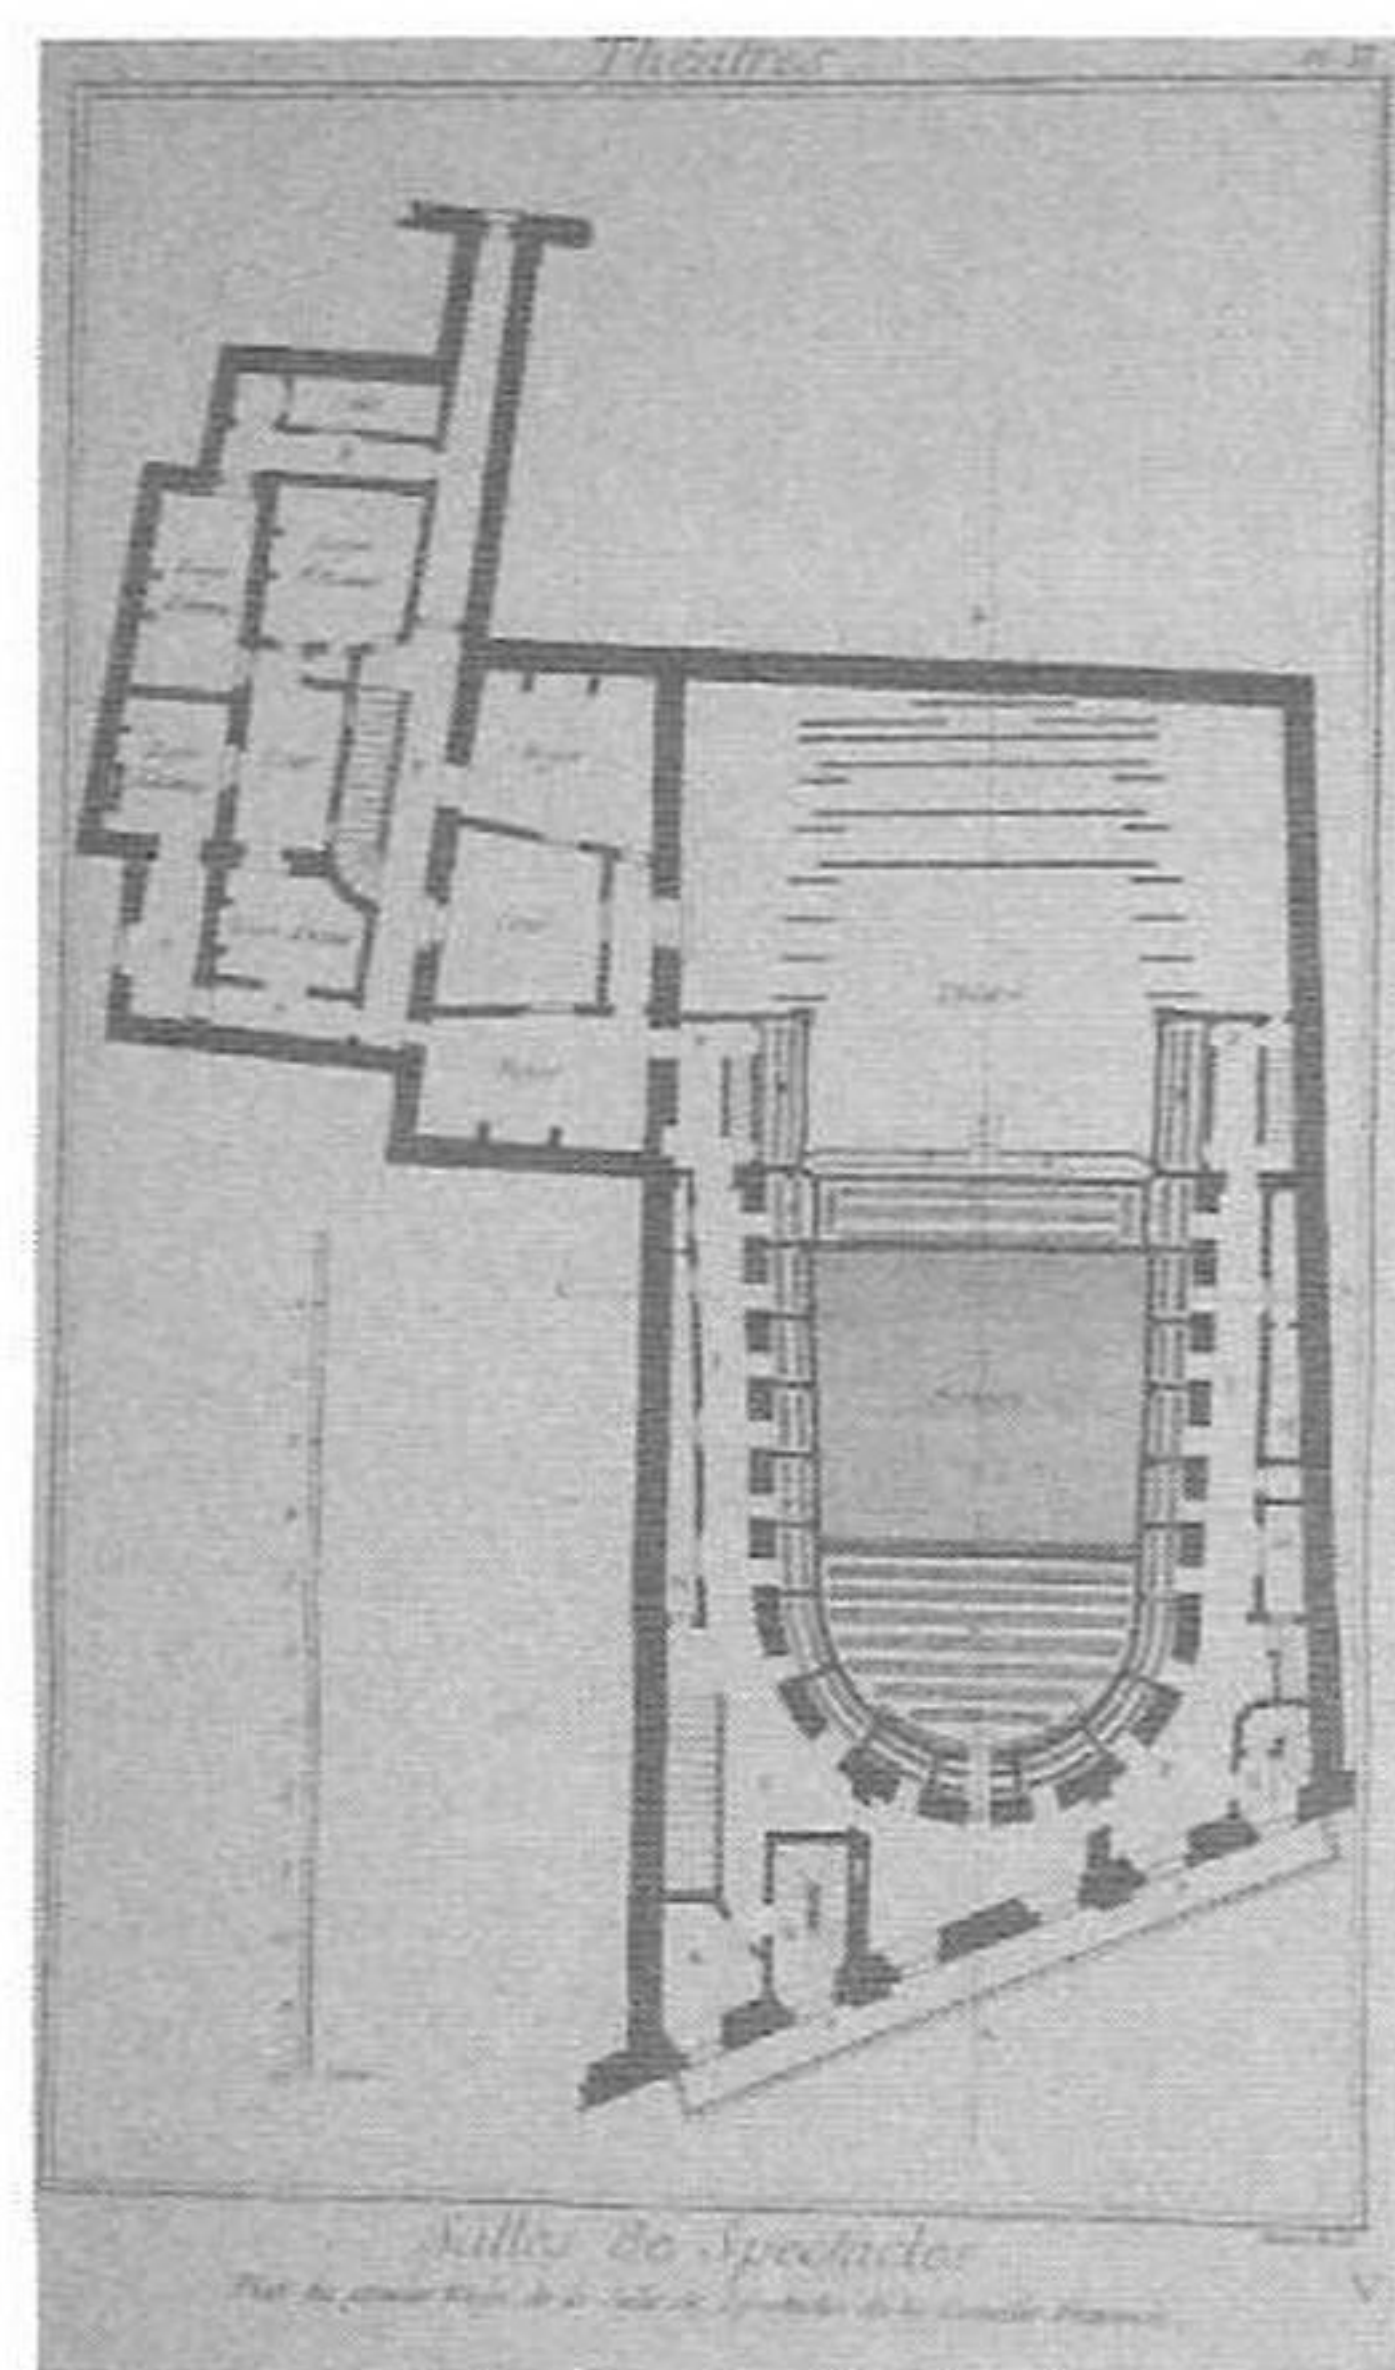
Comédie Française, plan du premier étage (*Encyclopédie*, Planches, «Théâtres»).
